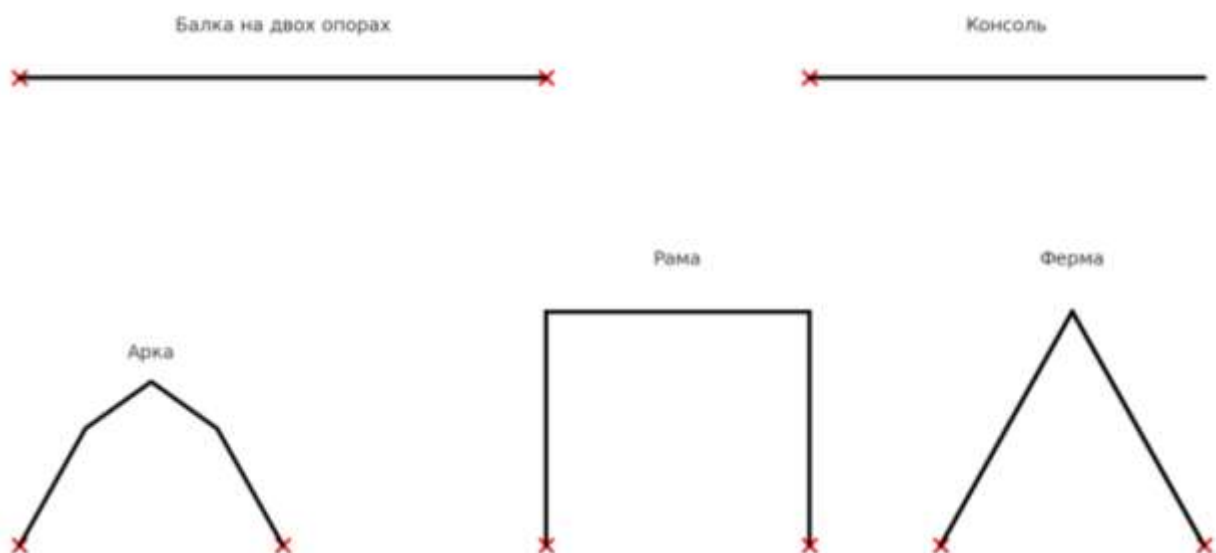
Приклади розрахункових схем будівельних конструкцій
